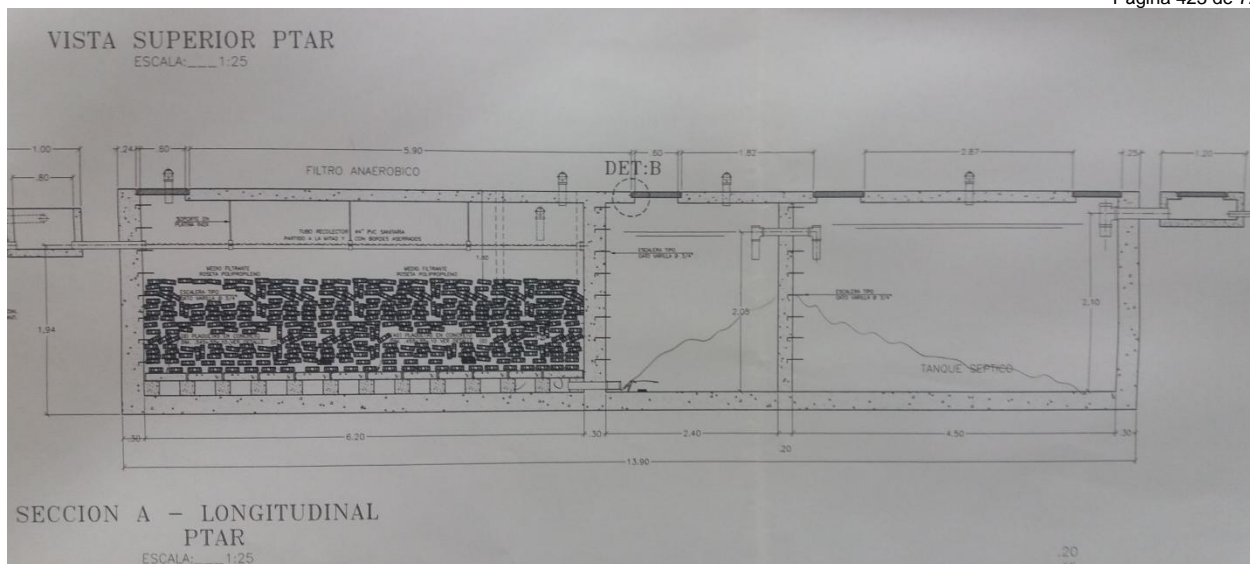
Sección A – Longitudinal PTAR. Fuente Plano No. 002.
